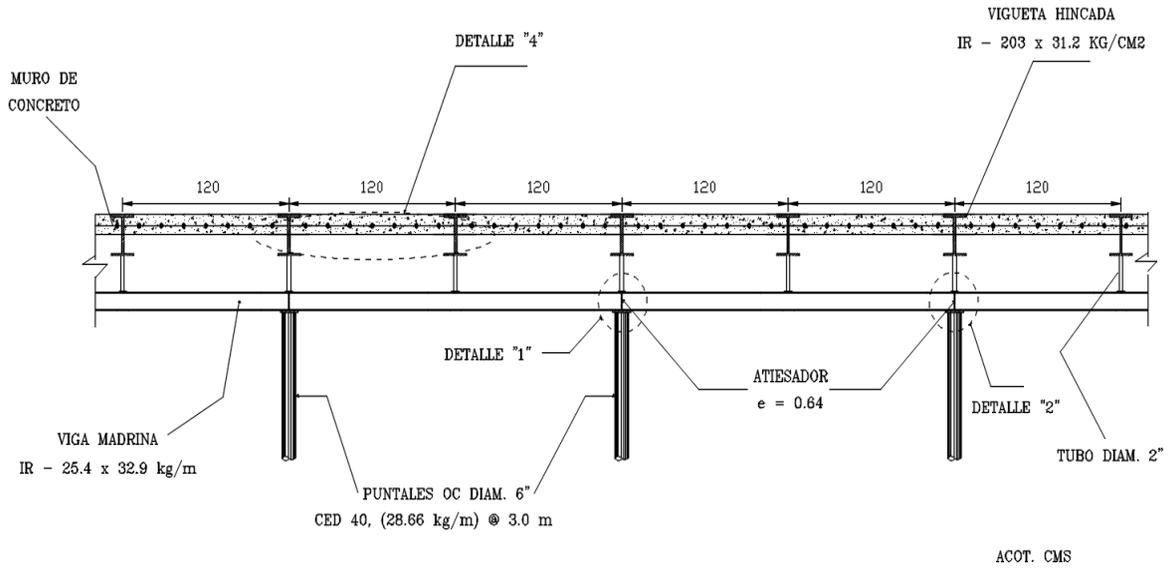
SISTEMA DE CONTENCIÓN.
